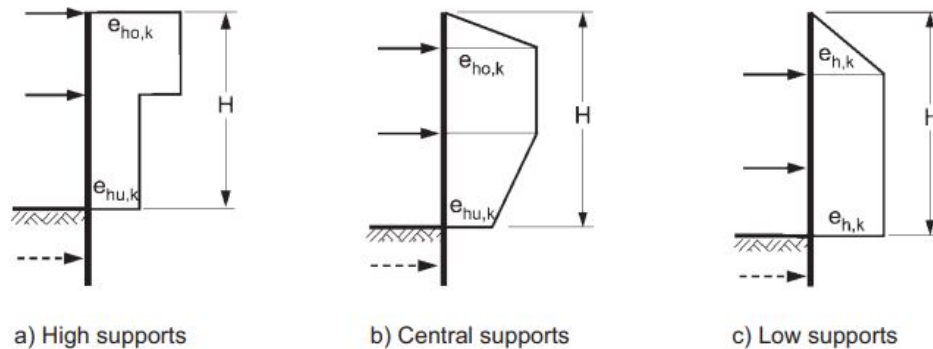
Diagramas de empujes de suelo para pilas doblemente arriostradas según su ubicación. (EAB, 2008)
